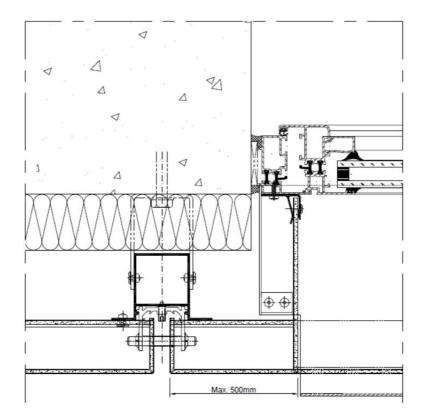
Détail jambage de fenêtre – coupe horizontal
